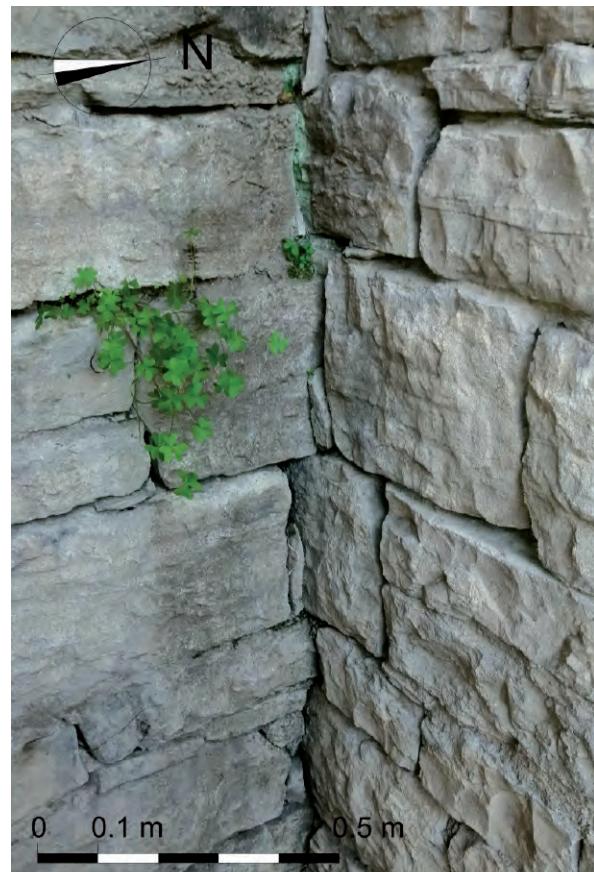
Detalle del encastre entre la fachada oeste y uno de los pequeños muros que se adosa al muro perpendicular occidental.
